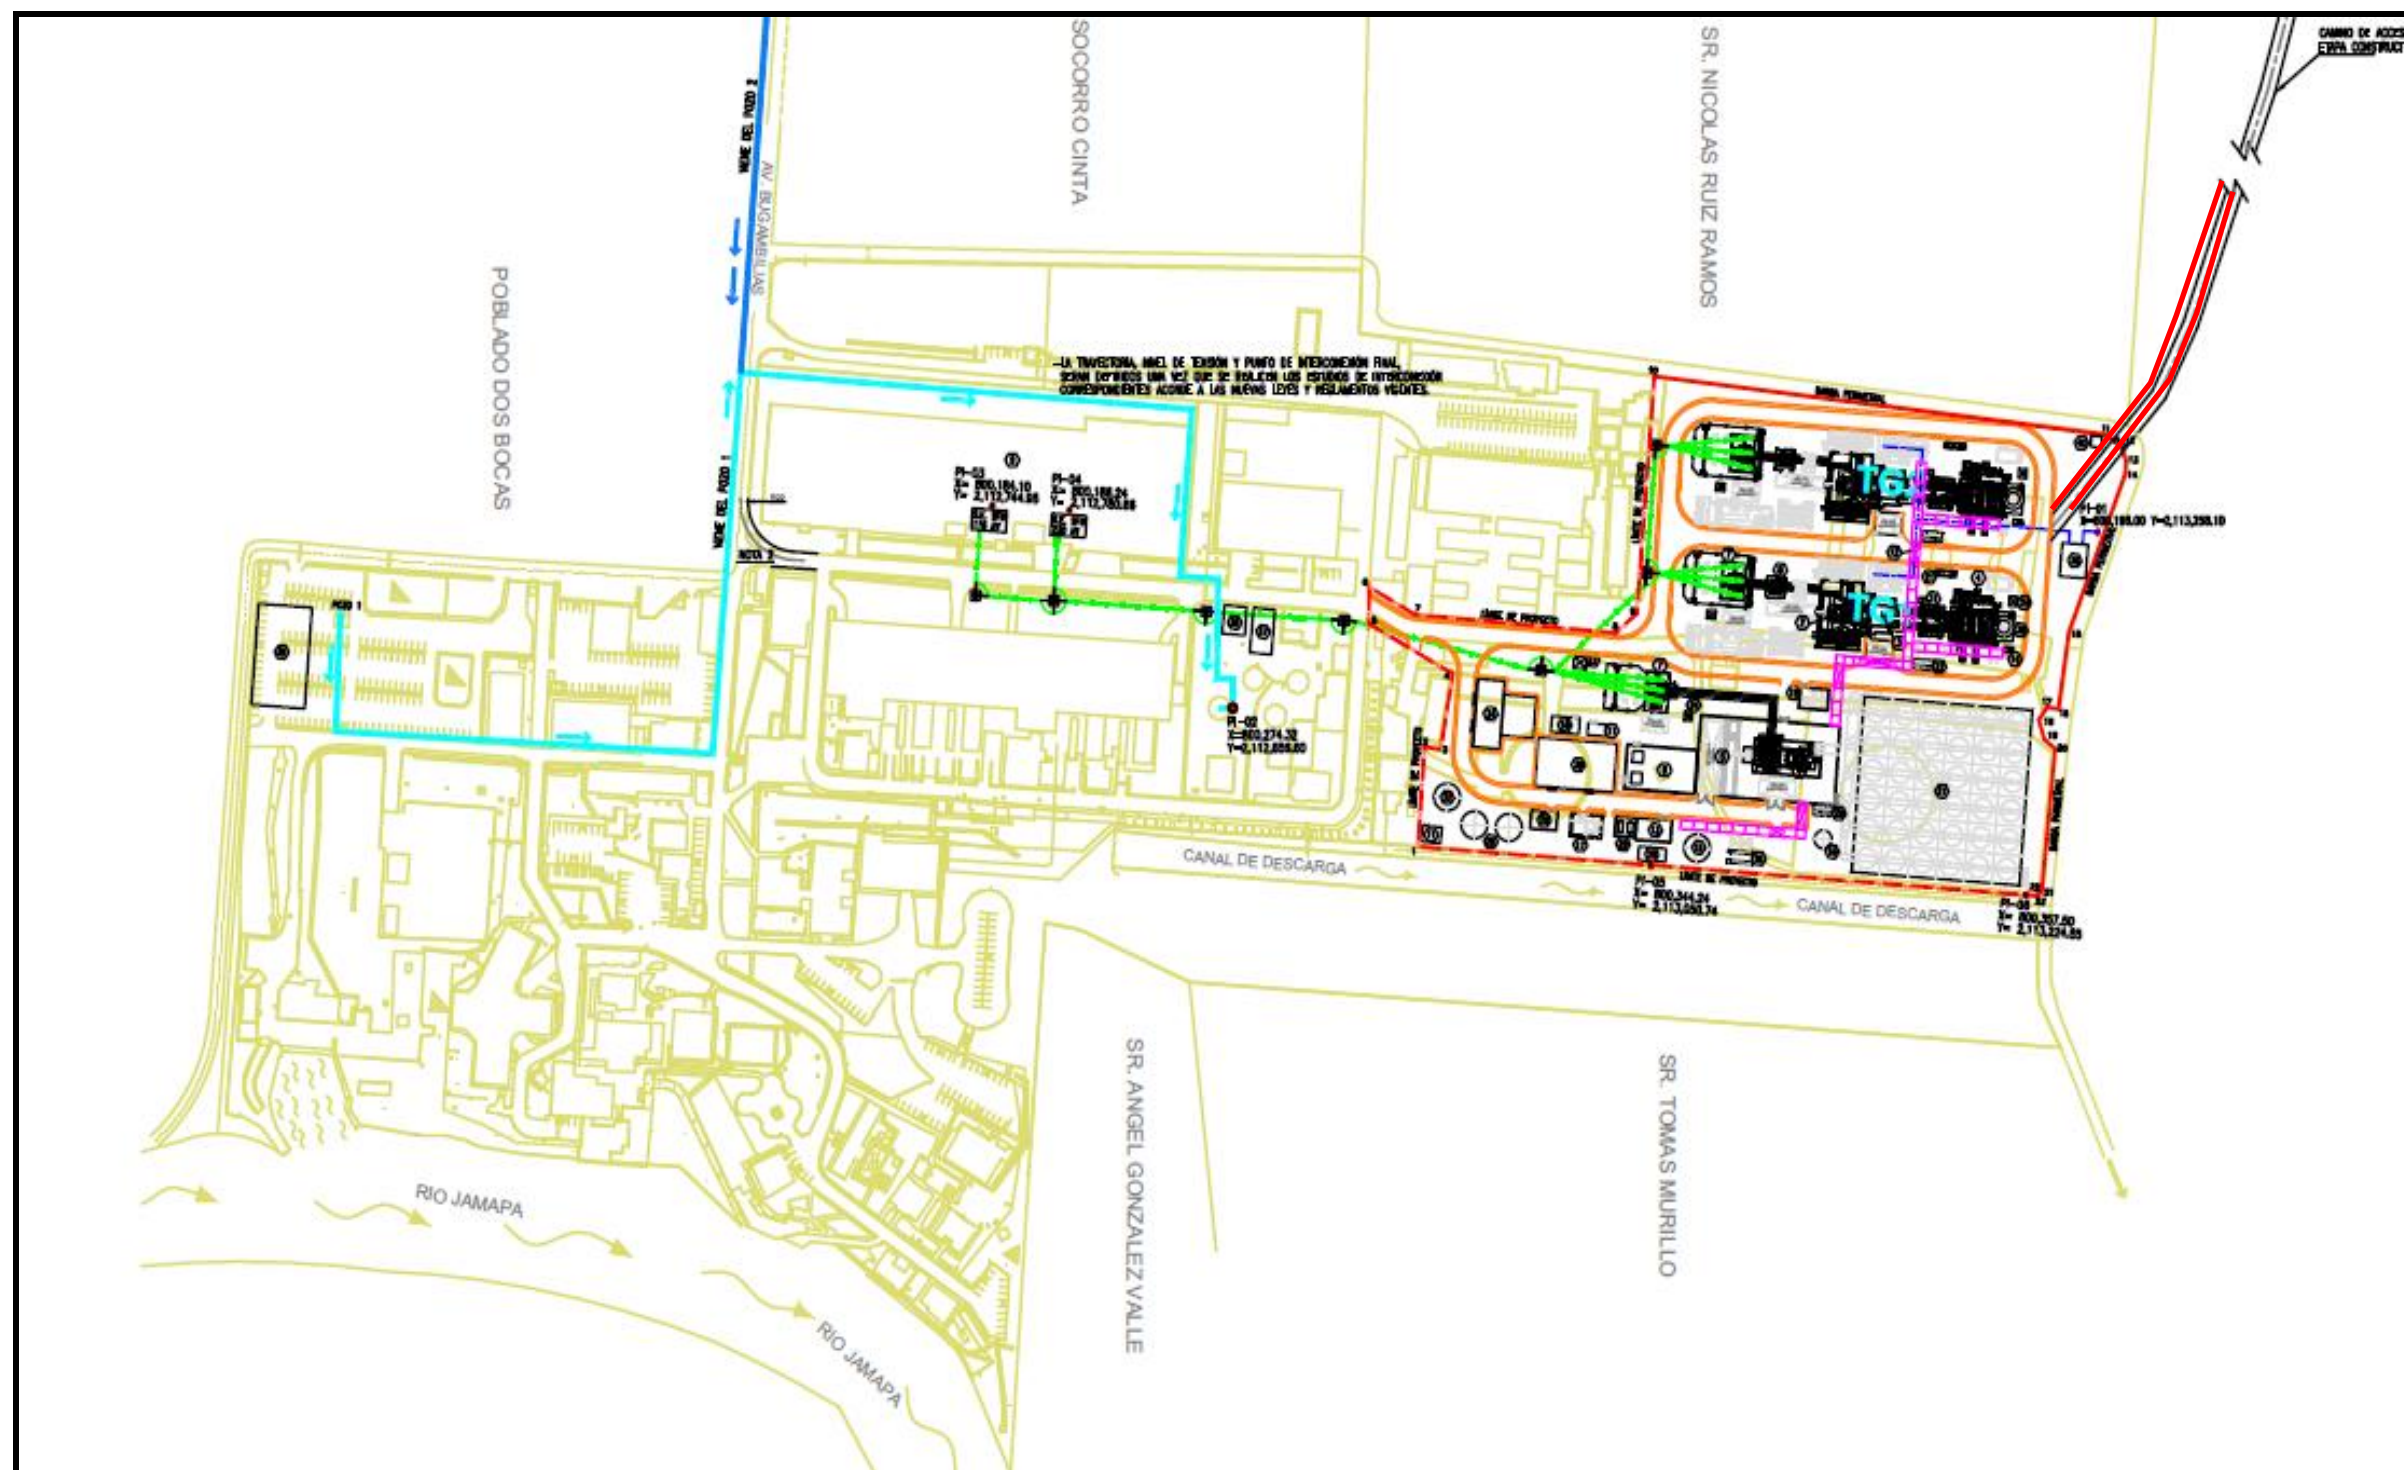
Arreglo de Proyecto CC Dos Bocas II, Plano P-150 (Anexo II-6)
